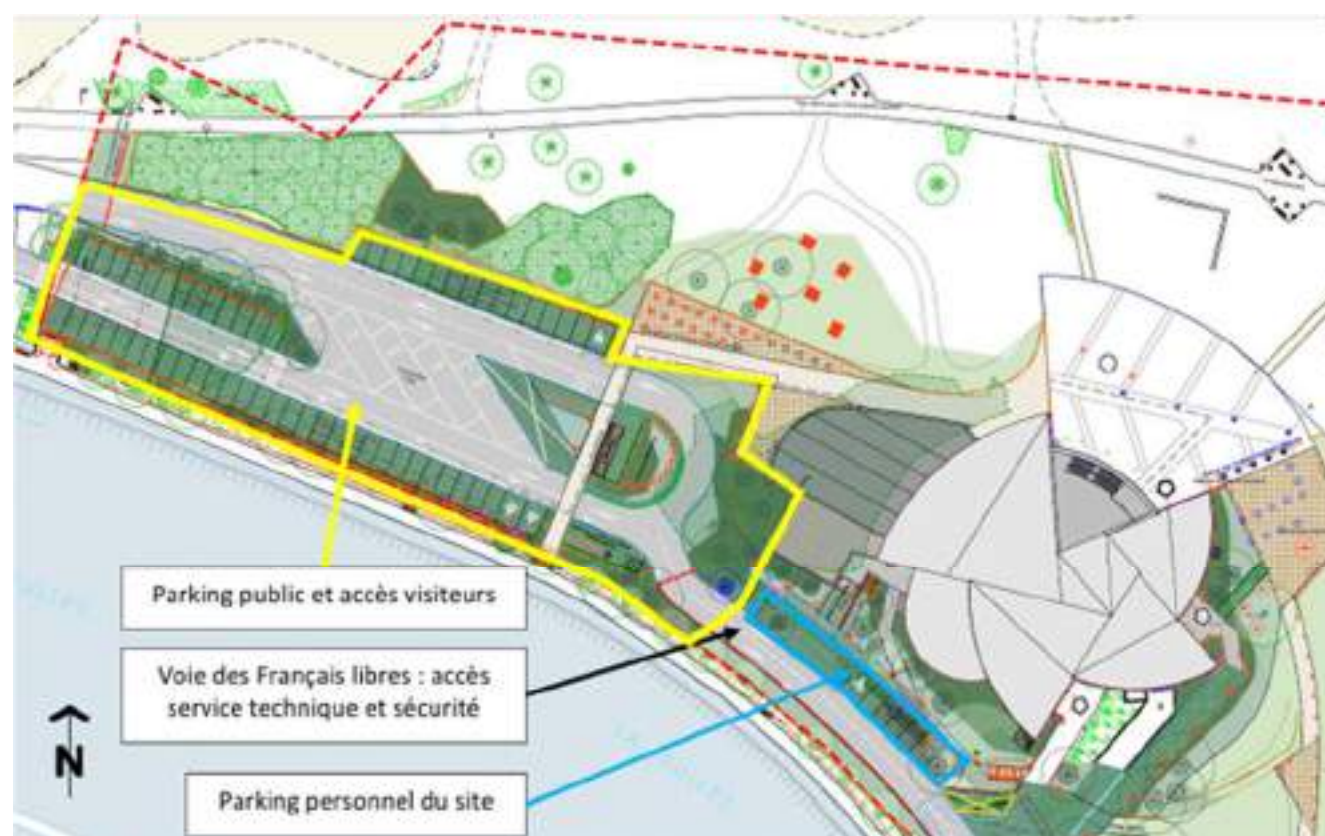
Extrait du plan d'aménagement (Source : Note AVP)
